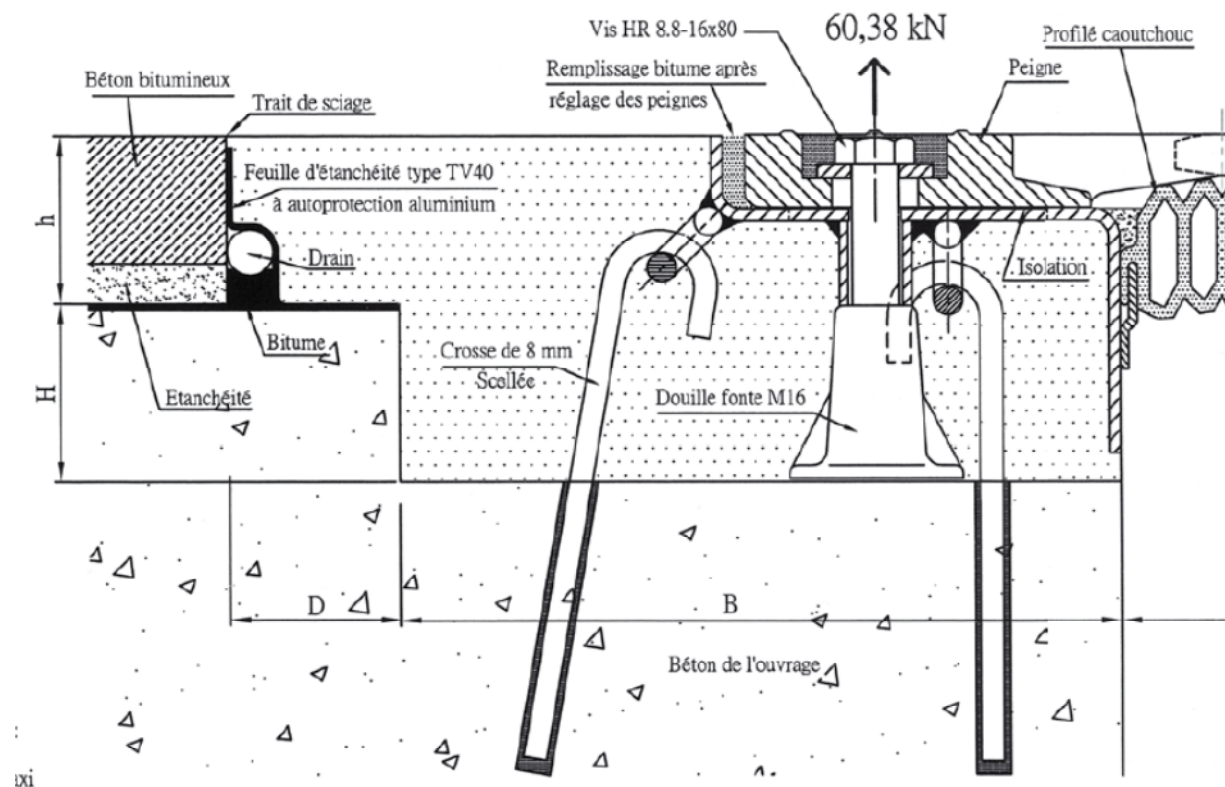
Coupe transversale du joint GTX 60-80 B2000
